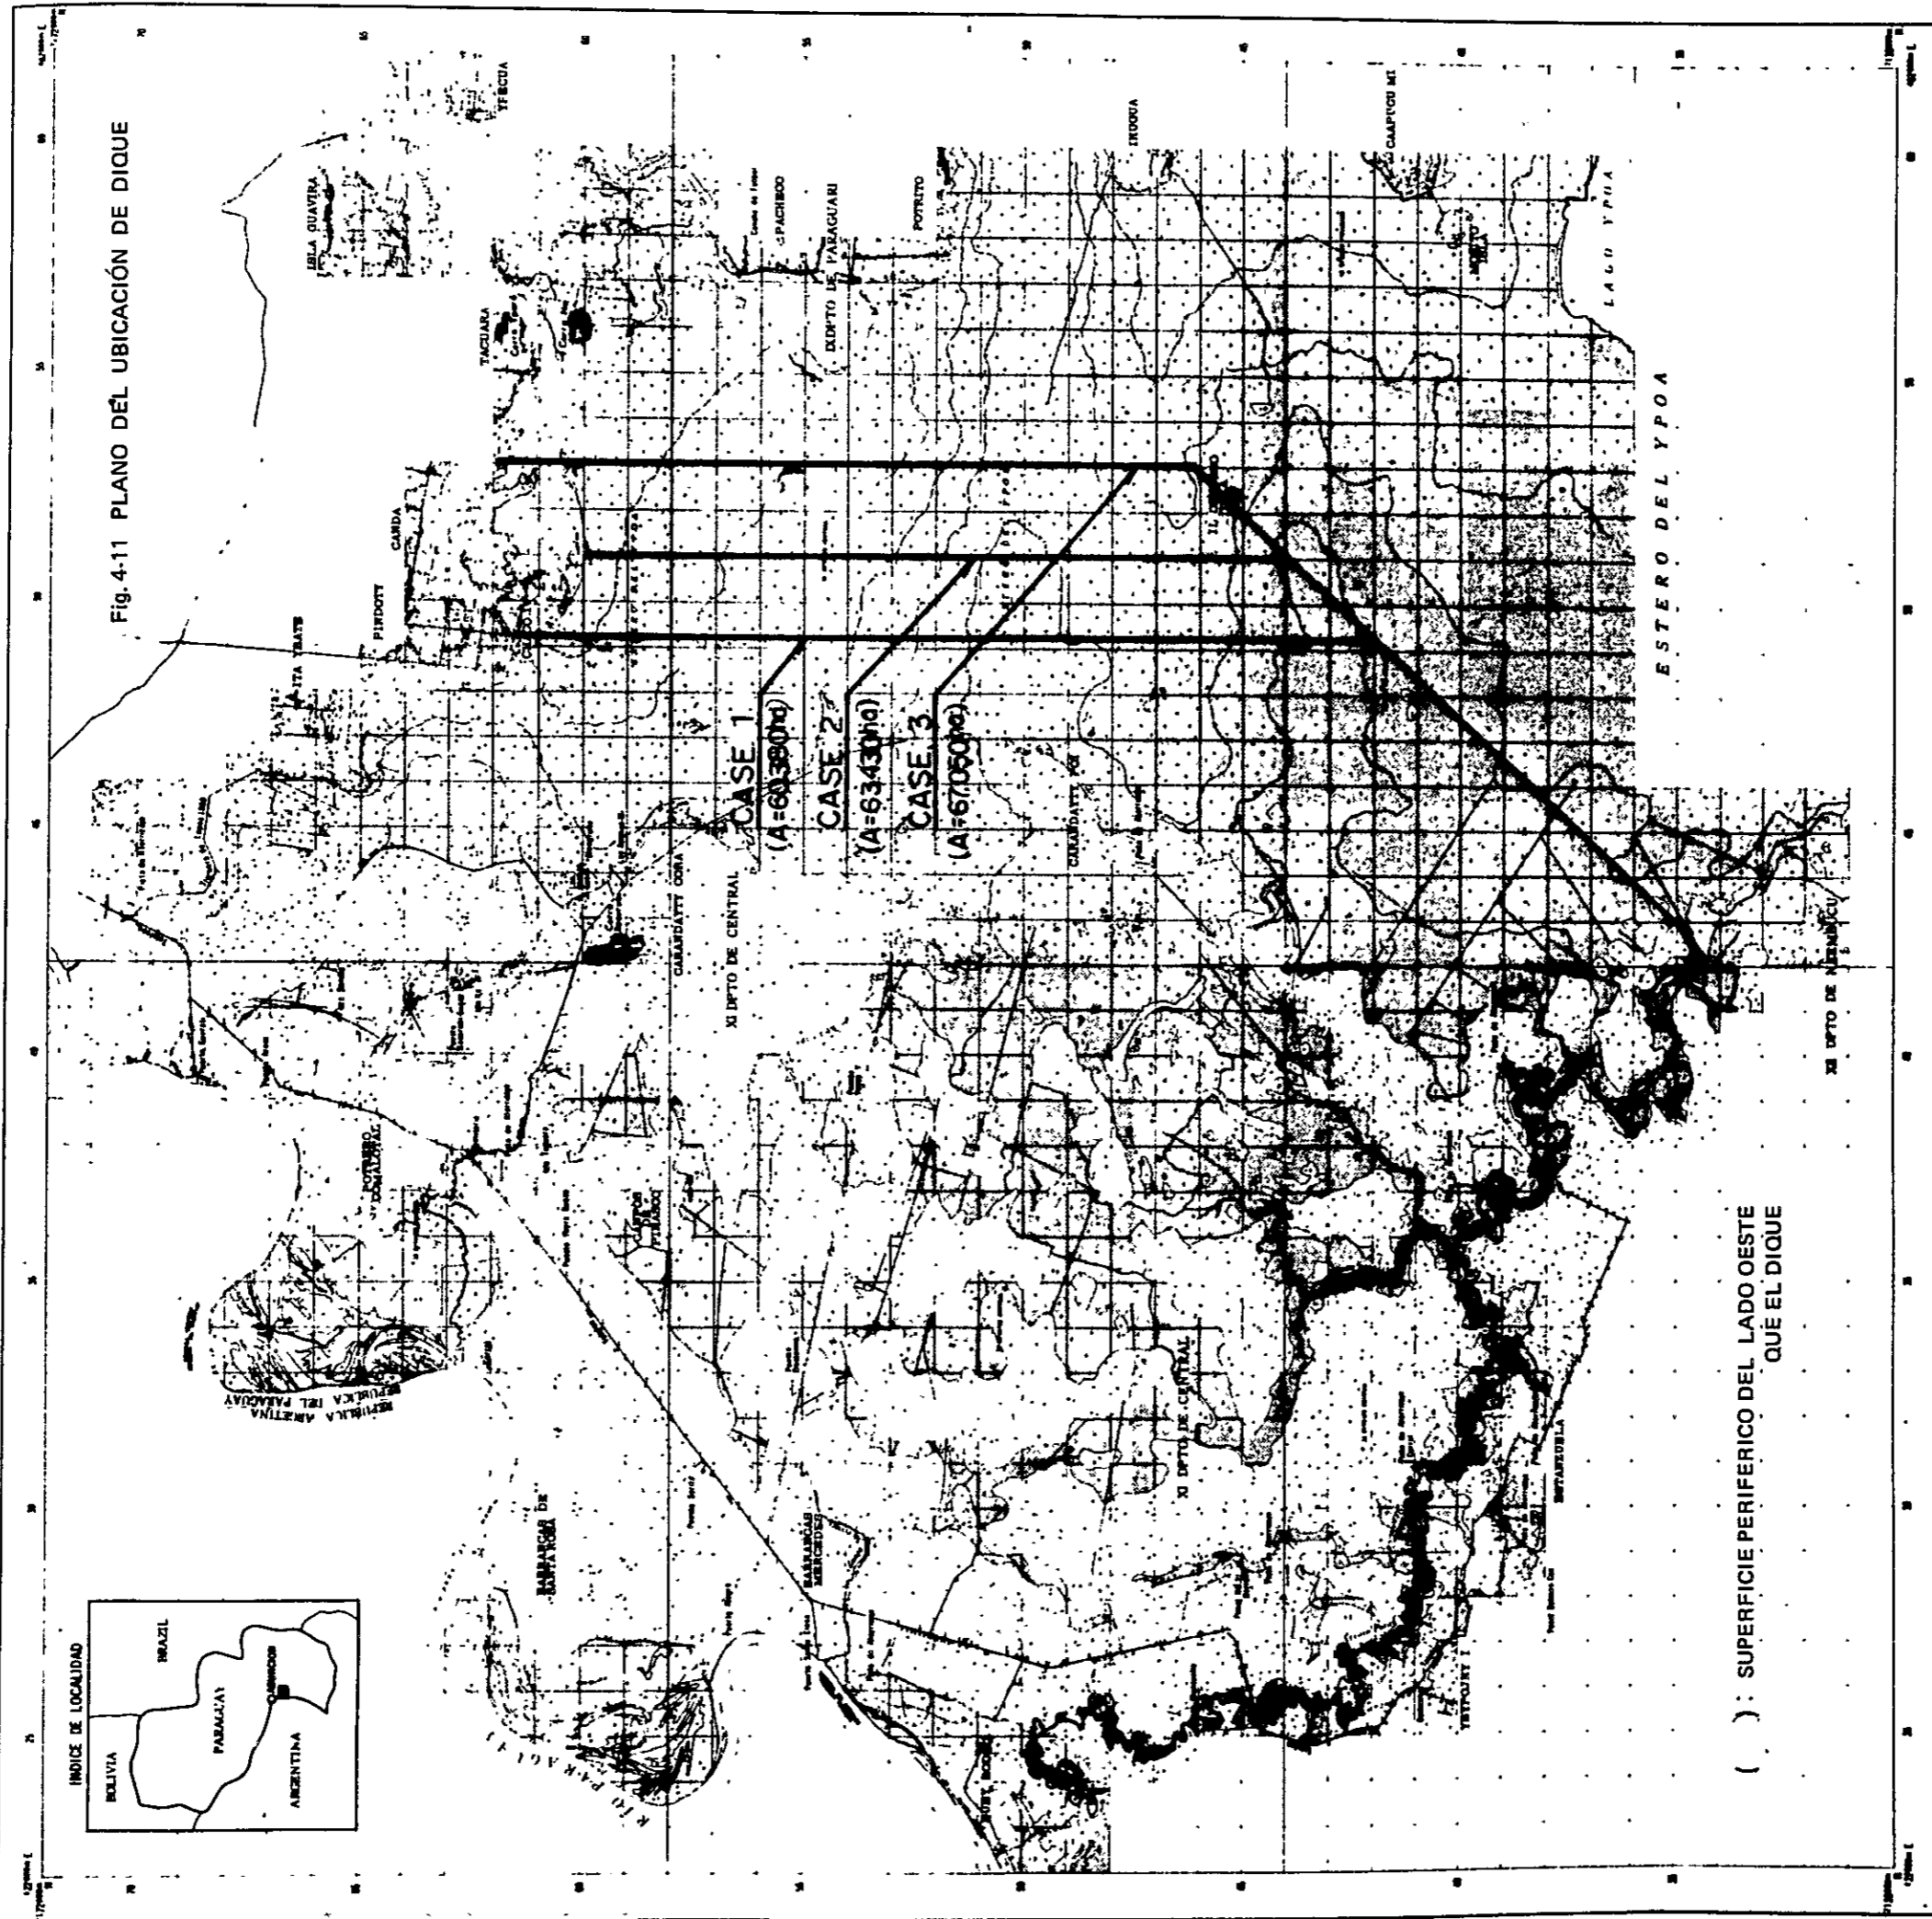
PLANO DEL UBICACIÓN DE DIQUE
